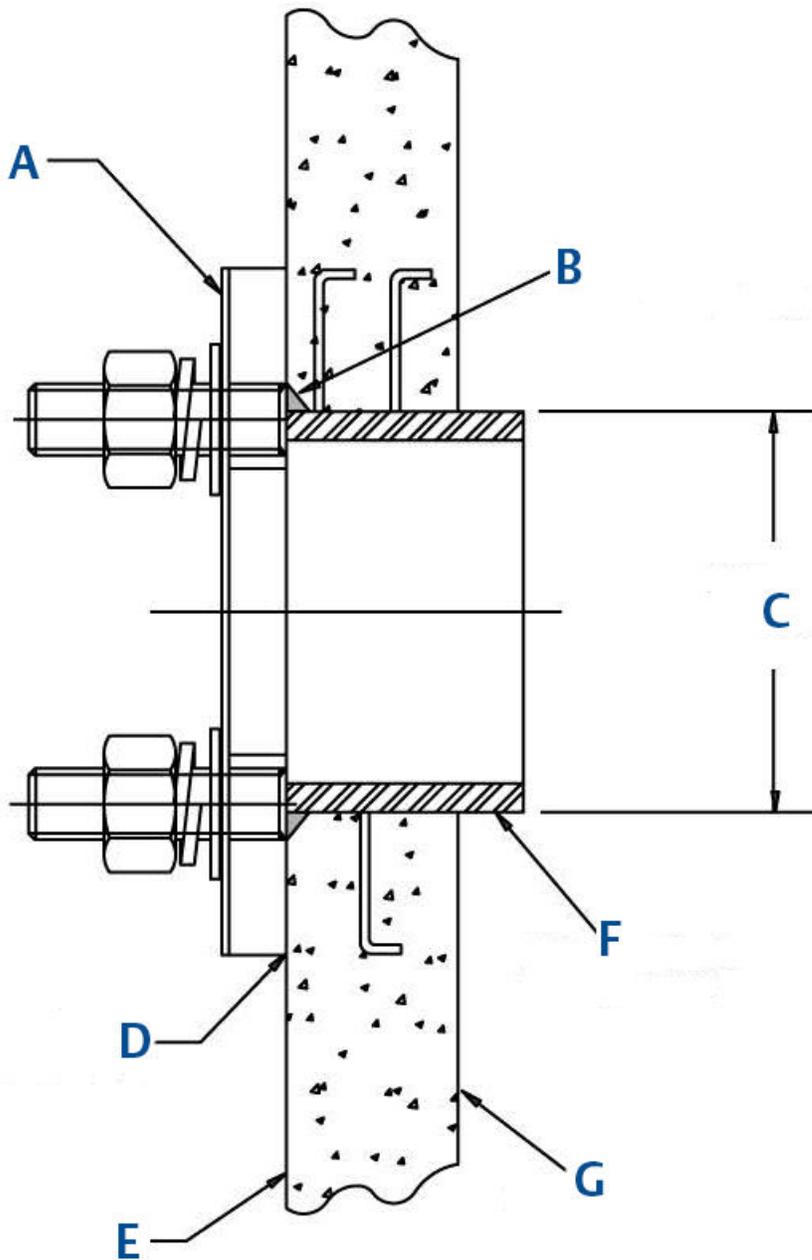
Construction d'une cheminée ou d'un conduit à paroi métallique
